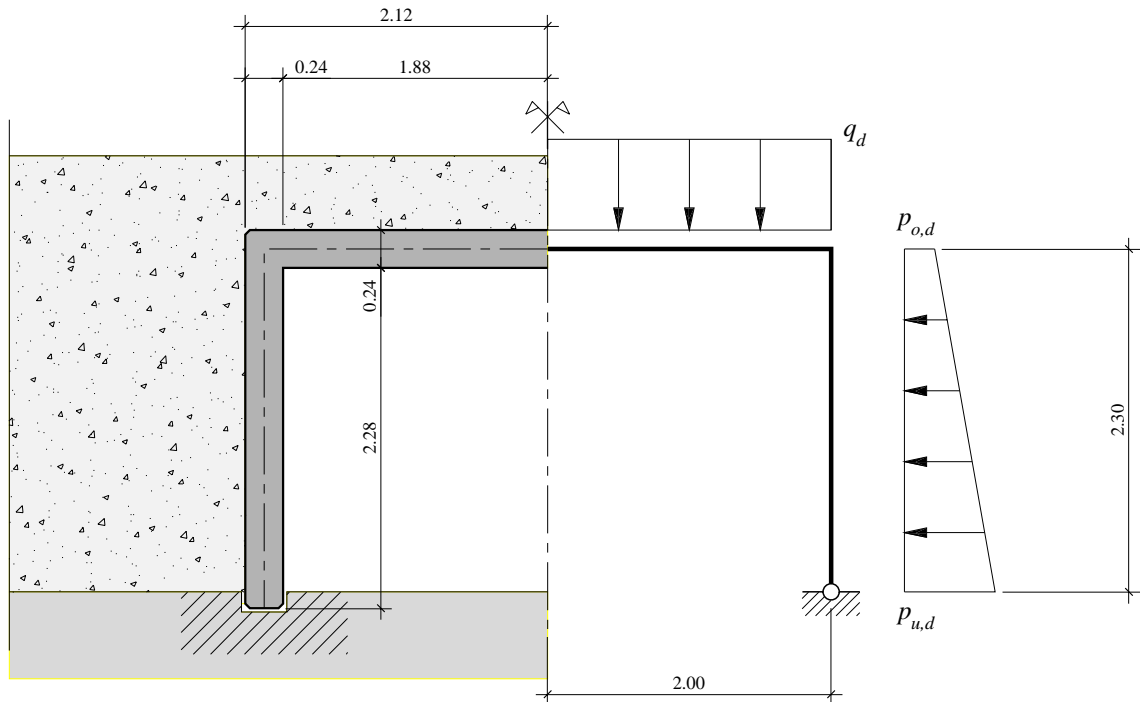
In Aufgabe 1 behandelte Fussgängerunterführung. Abmessungen in m.
